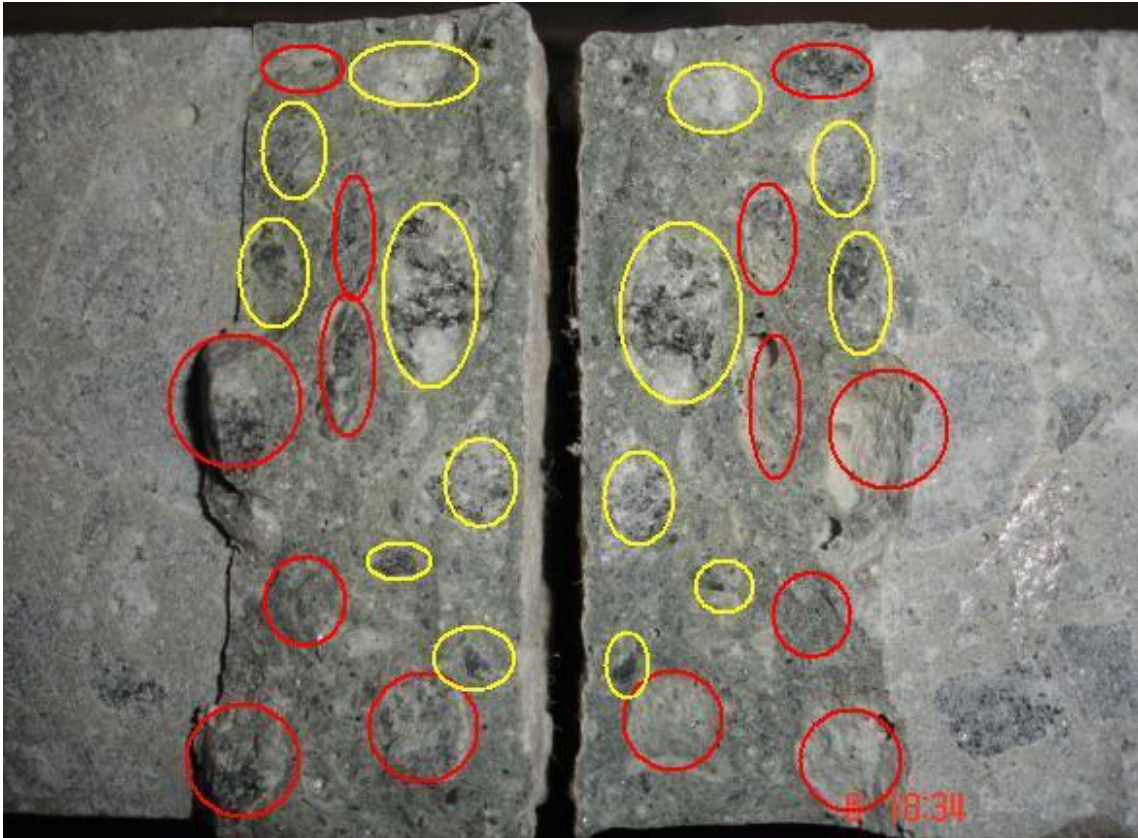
Superfície da viga M31 após a sua ruptura, concreto tipo B.
